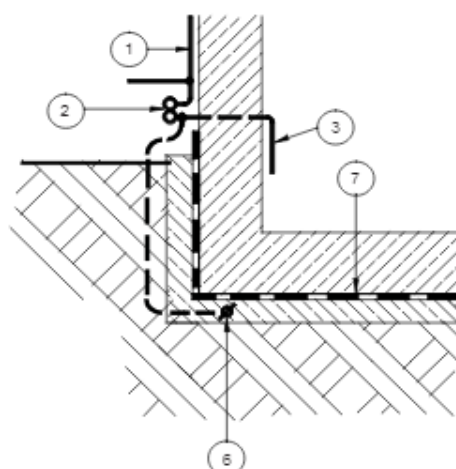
Fondazione Isolata con dispersore parzialmente nel terreno
